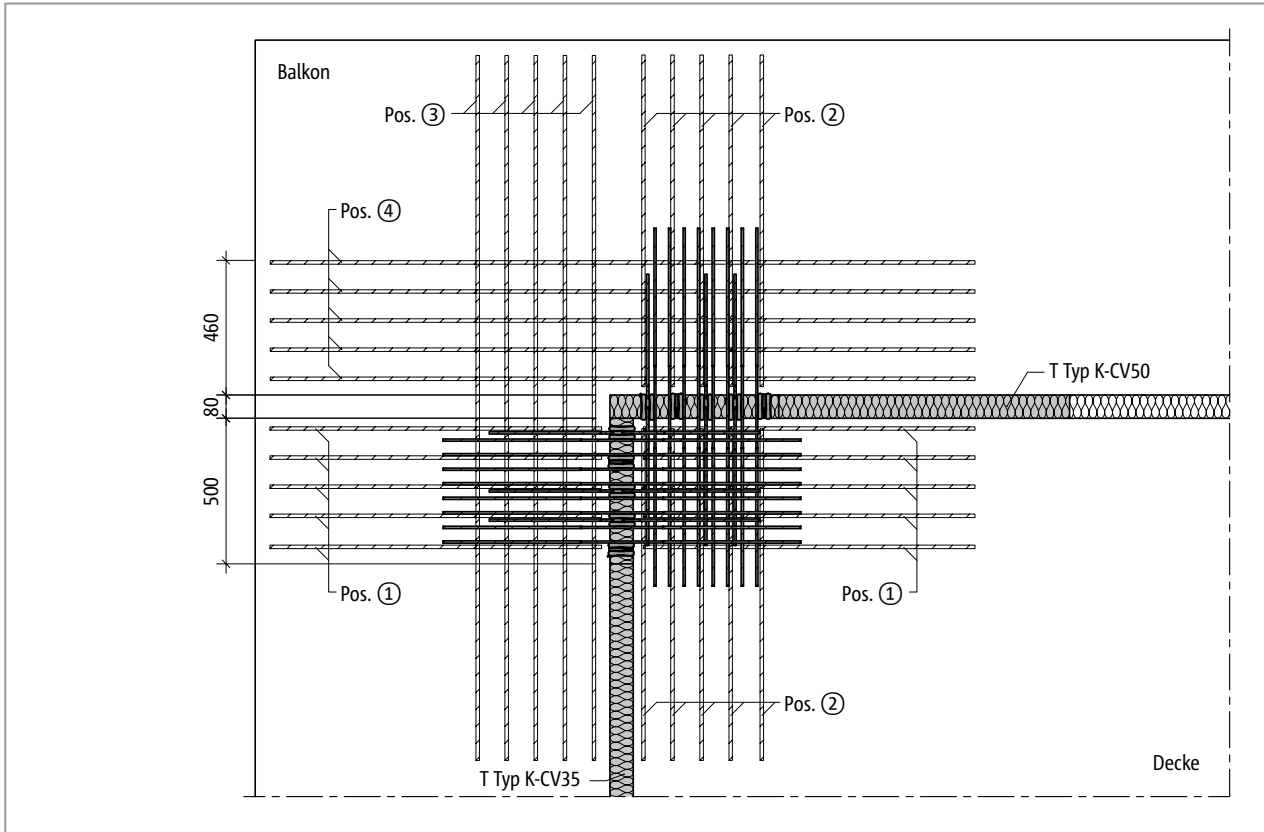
Schöck Isokorb® T Typ C-M1: Bauseitige Bewehrung (obere Lage)
